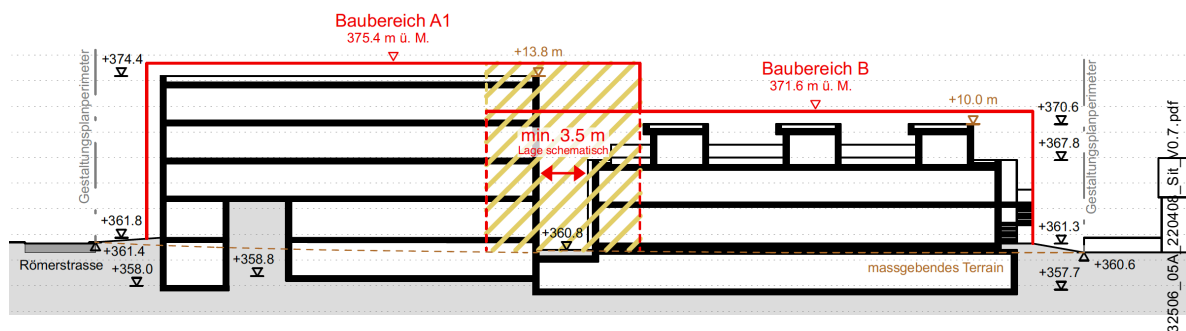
Auszug Schnitt DD aus Gestaltungsplan «Bachmatt» (08.04.2022, Planpartner AG)
